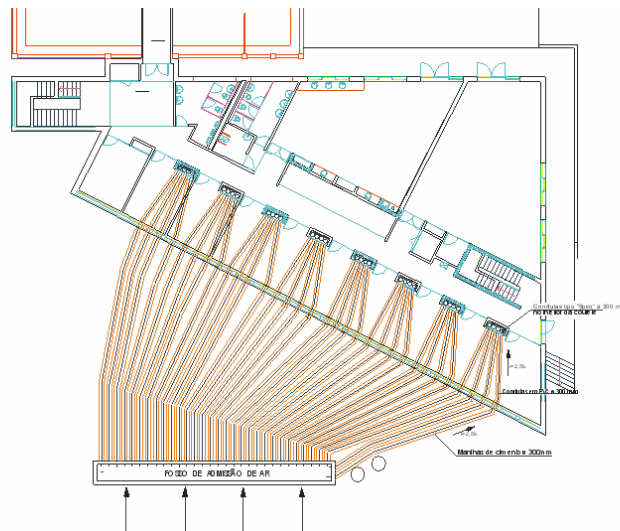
Planta de implantação dos tubos enterrados do “Solar XXI”. [55]
